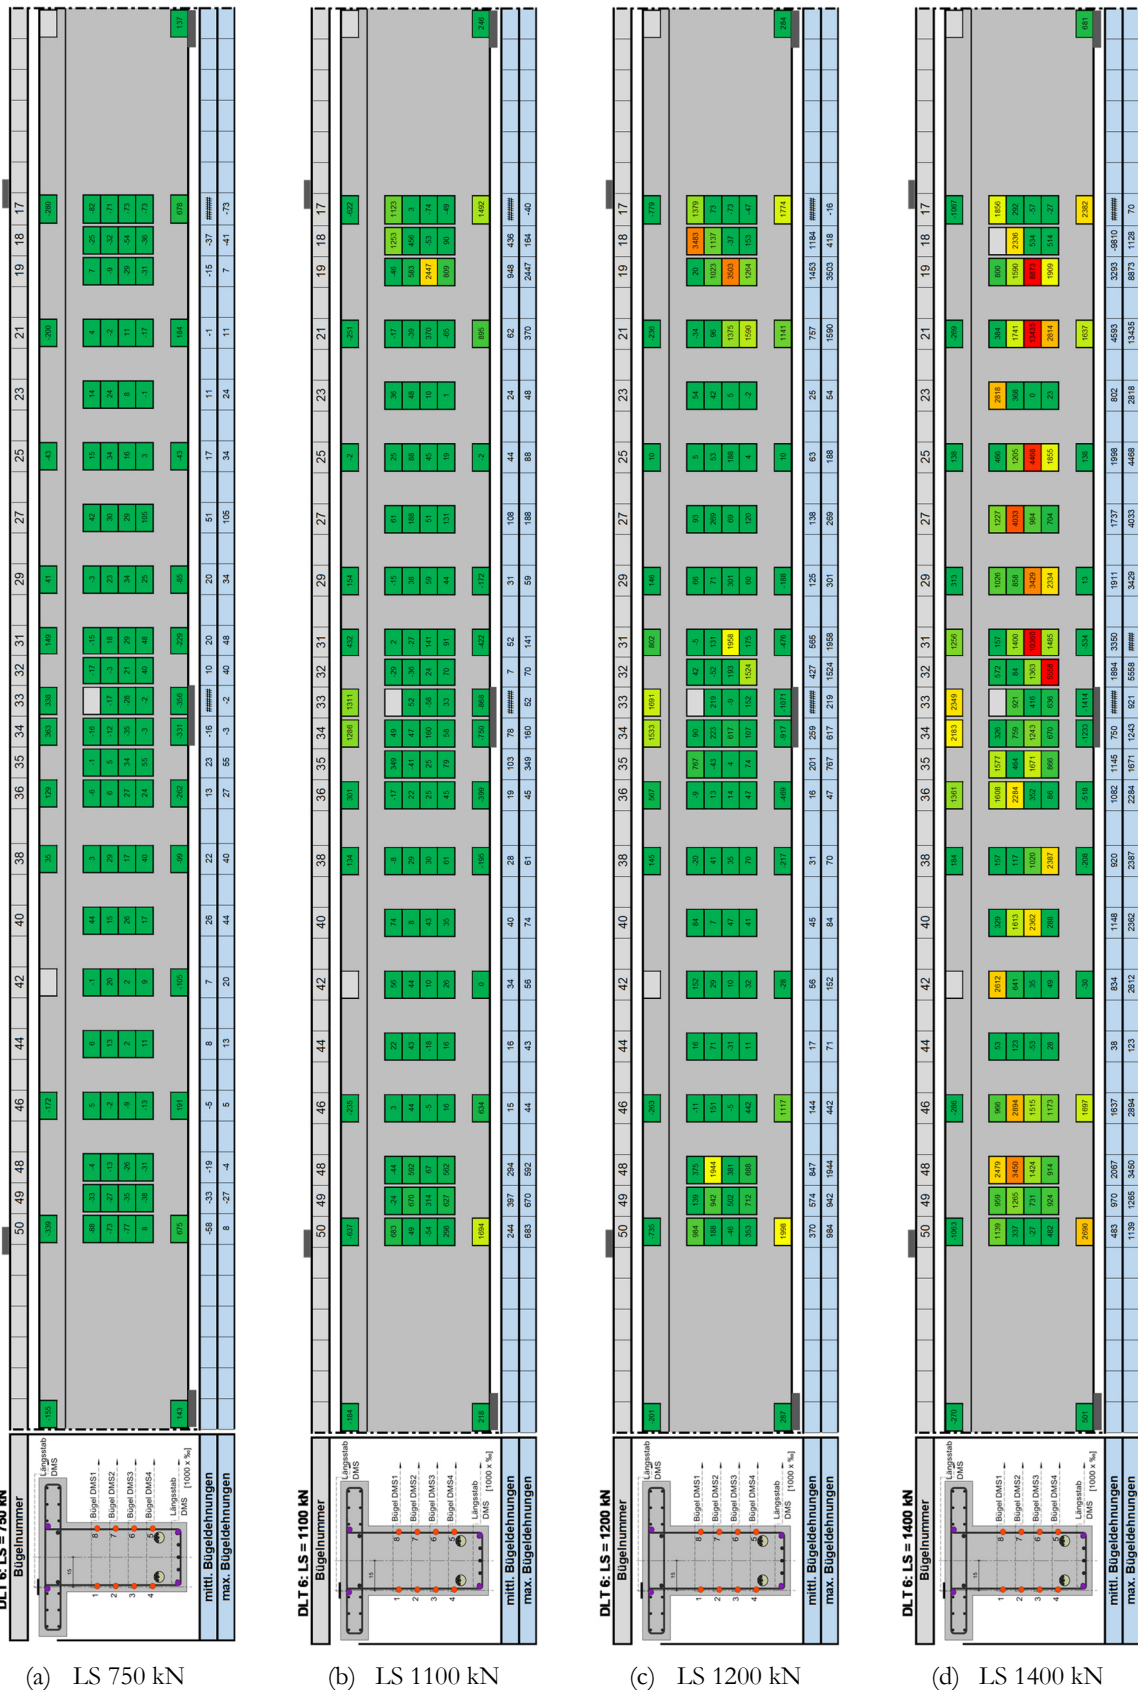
Betonstahldehnungen des Versuchsträgers DLT 6 für ausgewählte Laststufen – Vorderseite, Teil 1
